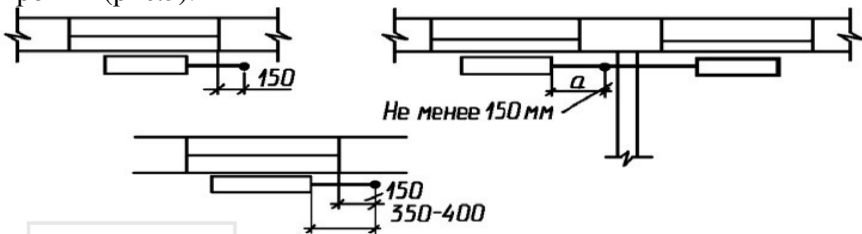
Схеми прив'язки стояків до будівельних конструкцій
